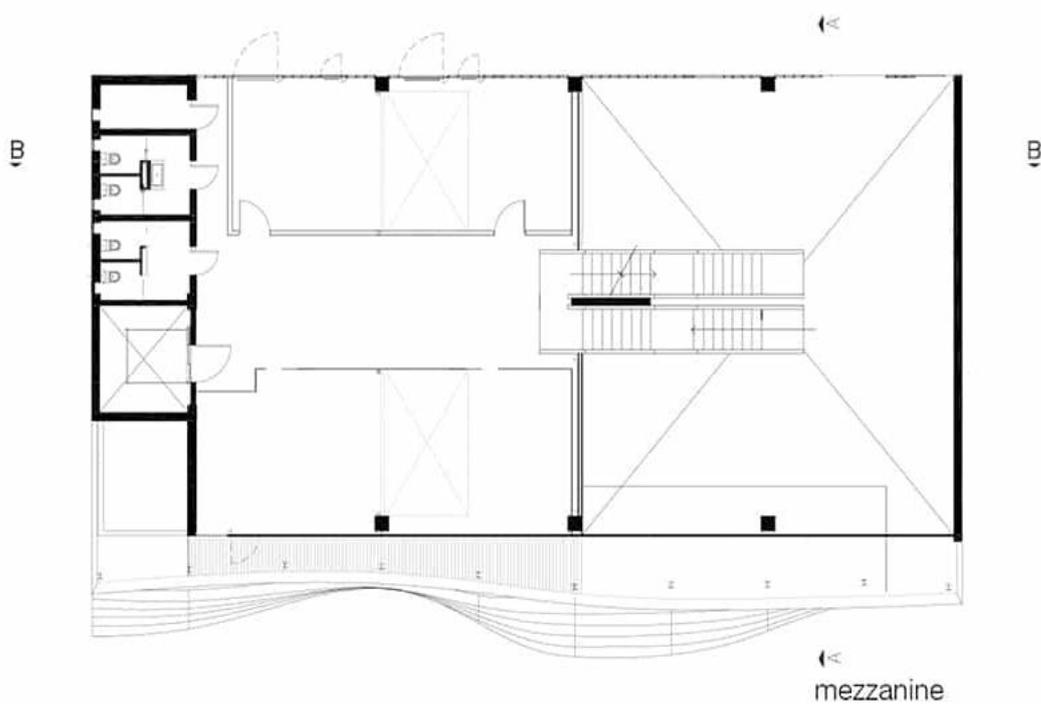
Edf. Colômbia, planta baixa primeiro pavimento.
